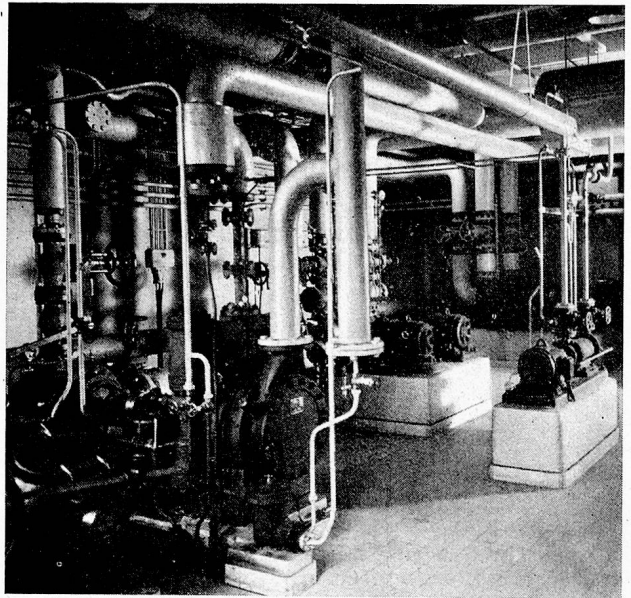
Centrale de Pierre de Plan. Local des pompes. Pumpenraum des Fernheizwerks Pierre de Plan.
